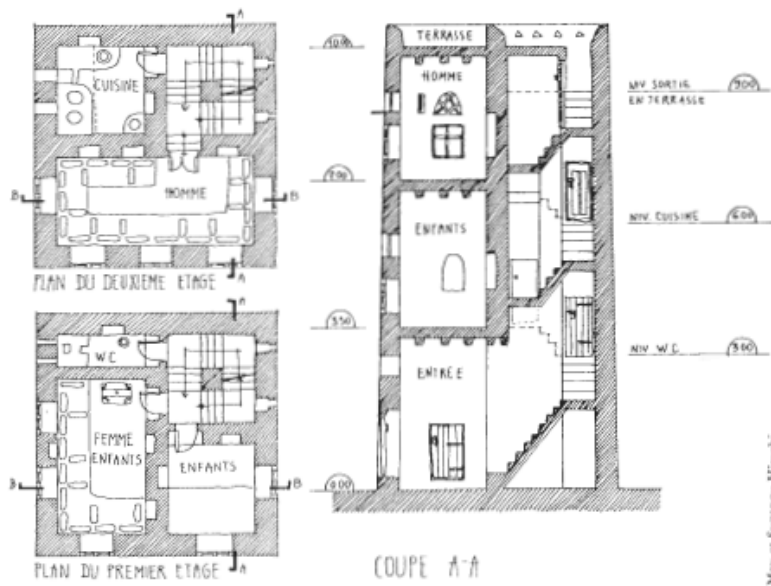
plan d'une construction a étages au Yémen, (source : craterre)
